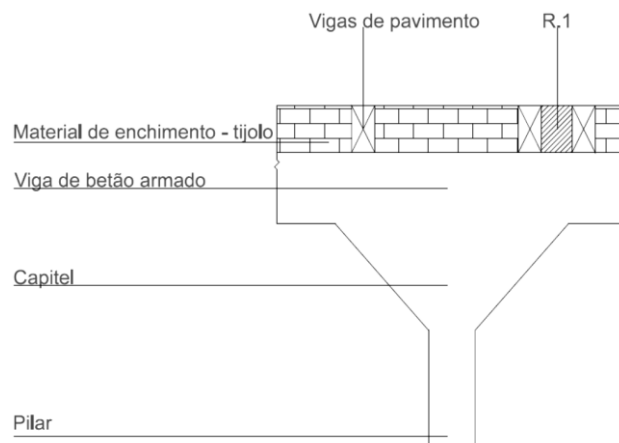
Corte representativo da ligação entre viga e pilar ilustrado a vermelho na Figura 44
